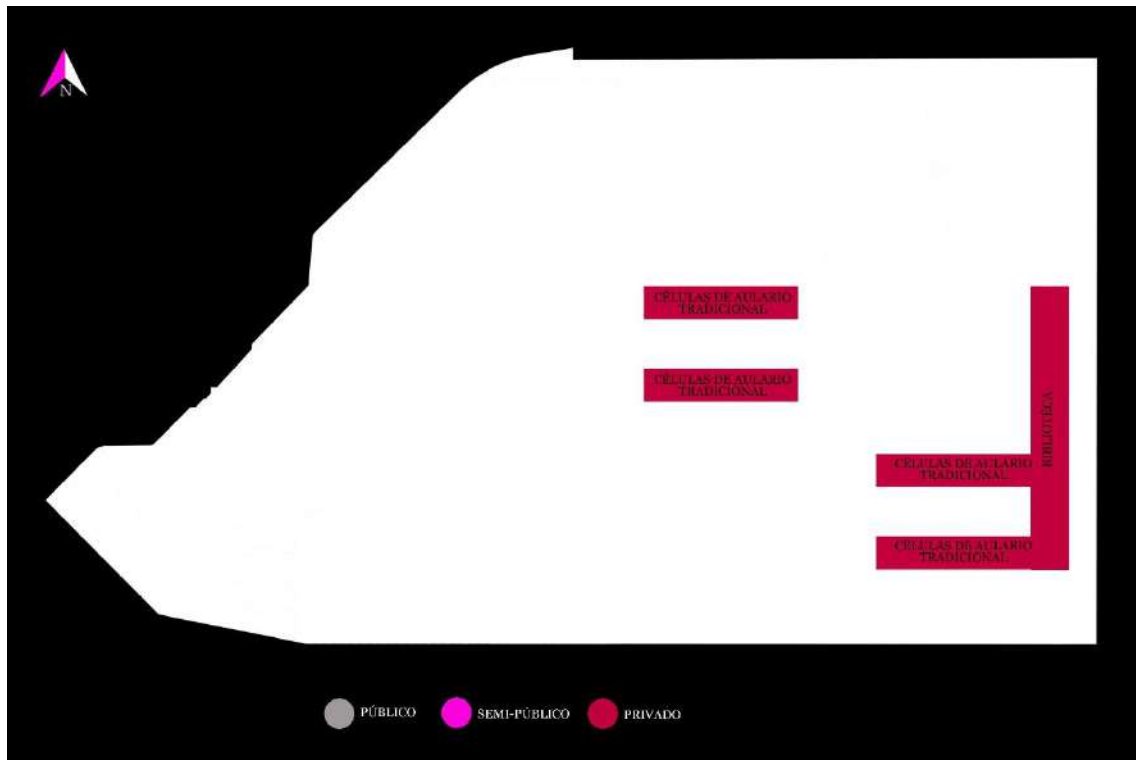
Zonificación por accesibilidad en segunda planta alta, en la propuesta de rediseño de la UEM´S.
